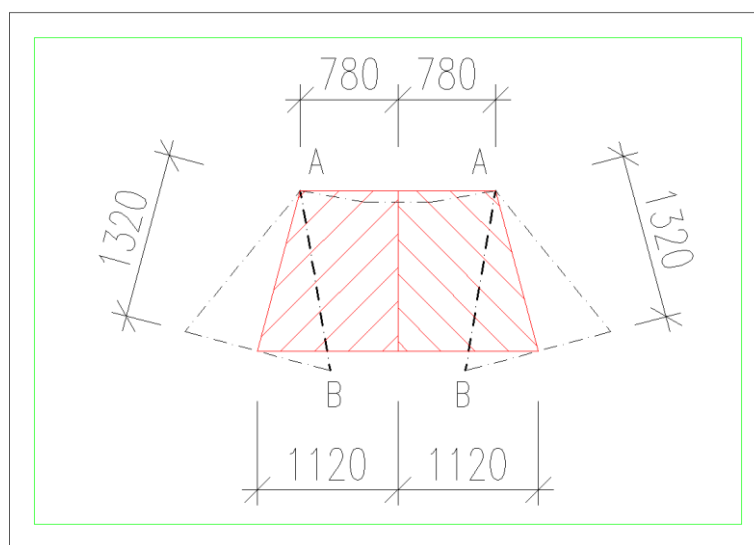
Výsek půdorysného průmětu konstrukce pro výpočet oblastí zatížení střešní konstrukce
